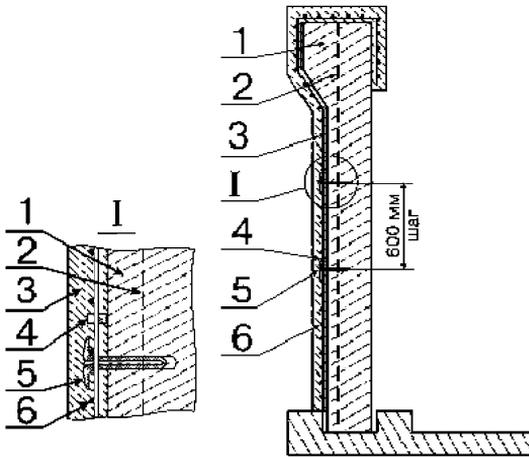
Подпорная стенка: 1 - усиливаемая конструкция (стена); 2 - арматура усиливаемой конструкции; 3 – торкрет-бетон усиления; 4 – полимерный ограничитель; 5 – анкер; 6 - дополнительная сетка из композитной арматуры
